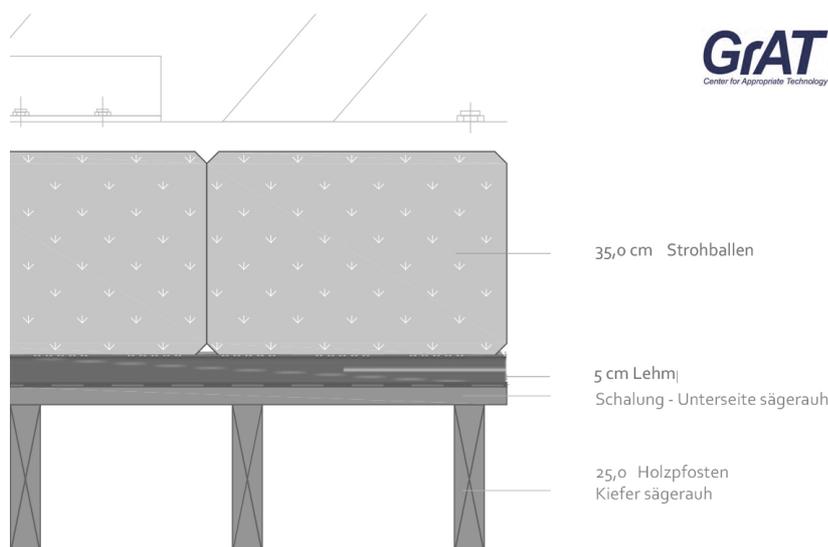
Dämmung oberste Geschossdecke. Detail Andi Breuss. Datenbank. GRAT. Renew Building. 2012.
